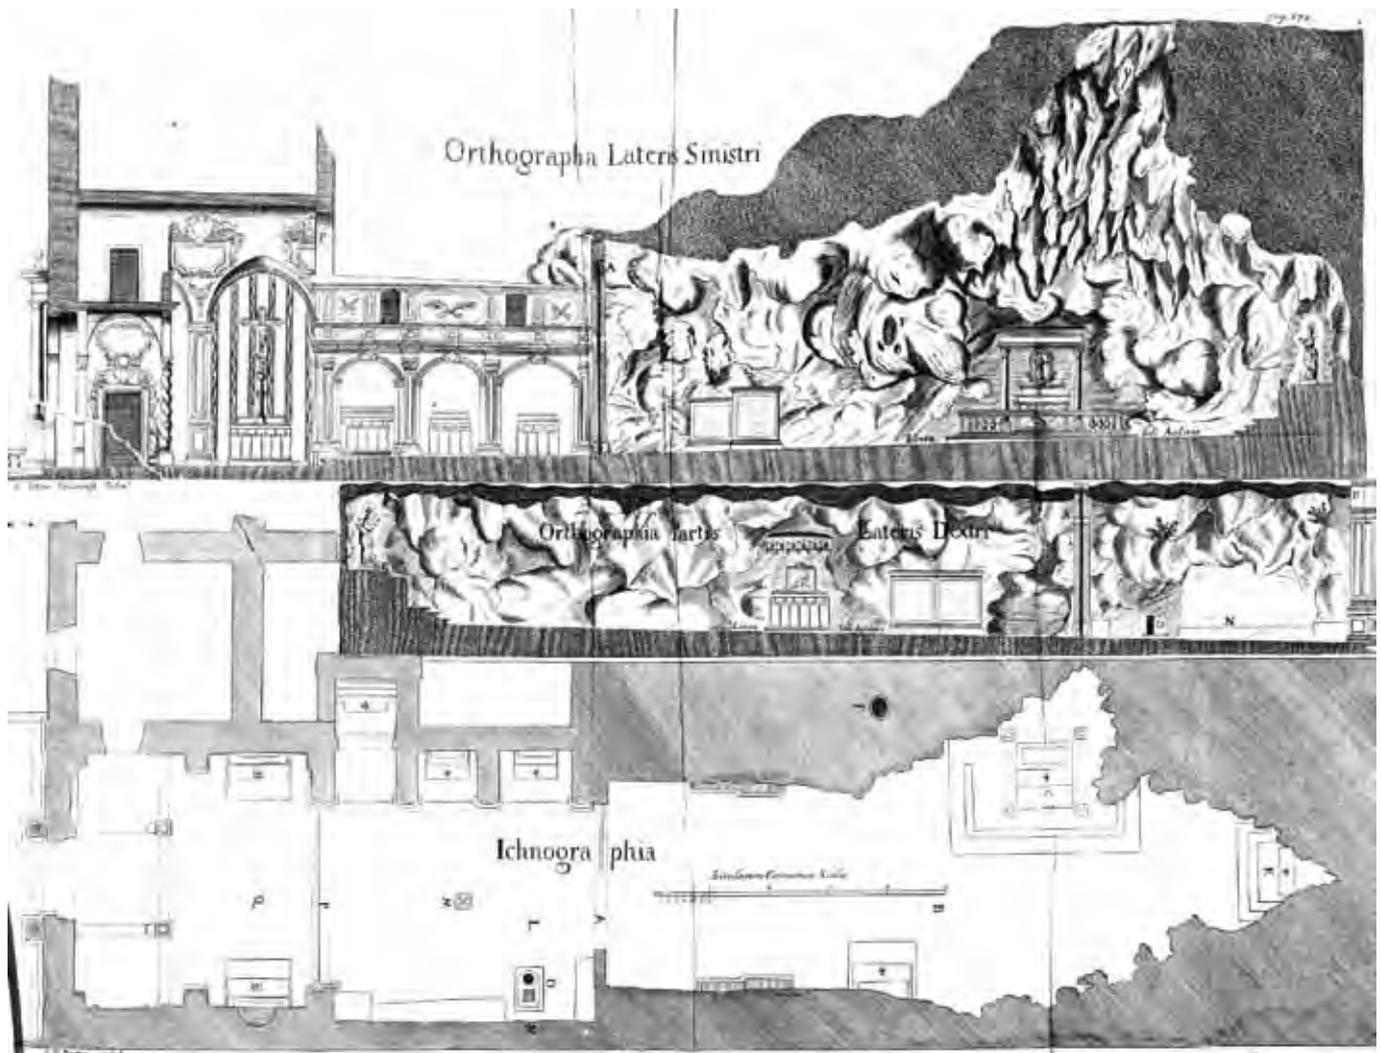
Pianta e sezione della Chiesa di Santa Rosalia edificata all'ingresso della Grotta di Santa Rosalia al Monte Pellegrino (Stiltingo, 1748).
